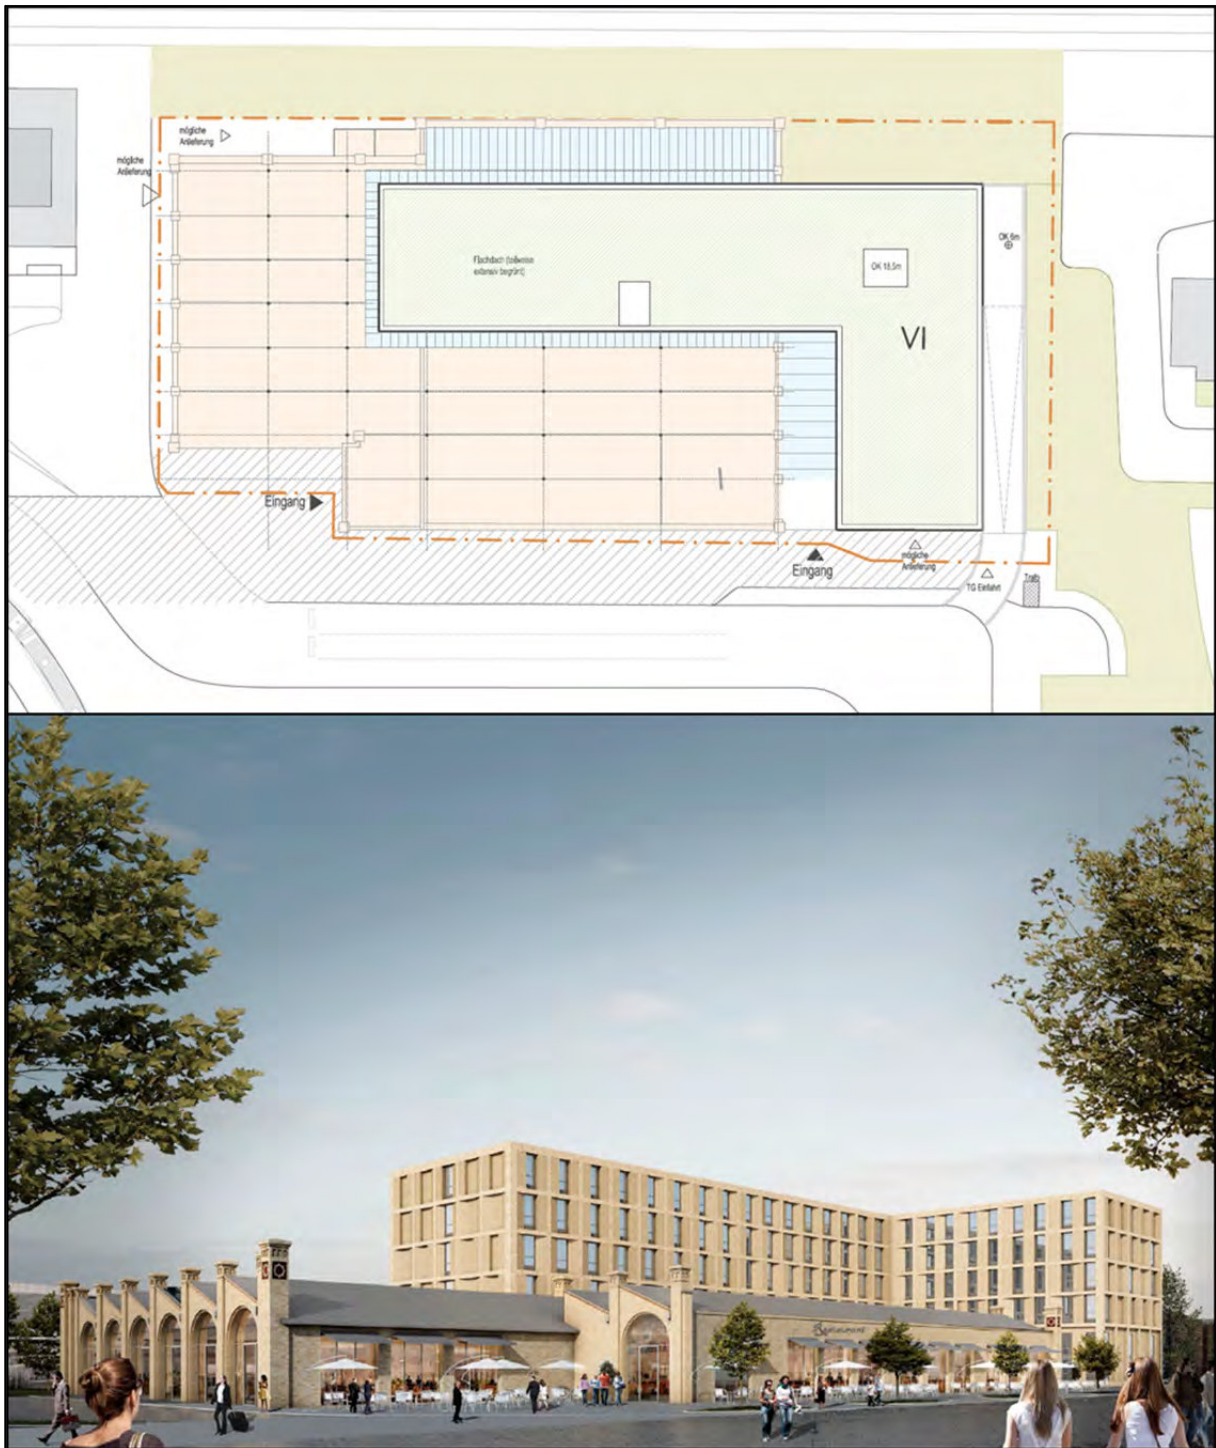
Lageplan des städtebaulichen Konzepts (Bild oben) und Visualisierung (Bild unten) gemäß /44/
